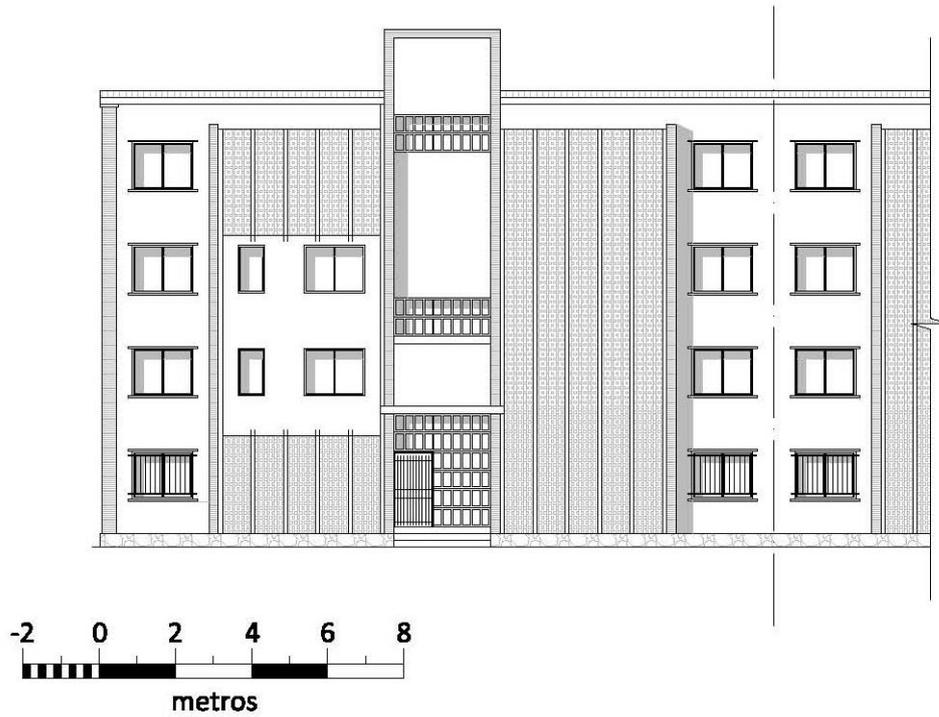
Plano de fachada norte, escalera 1. Escala 1:200
